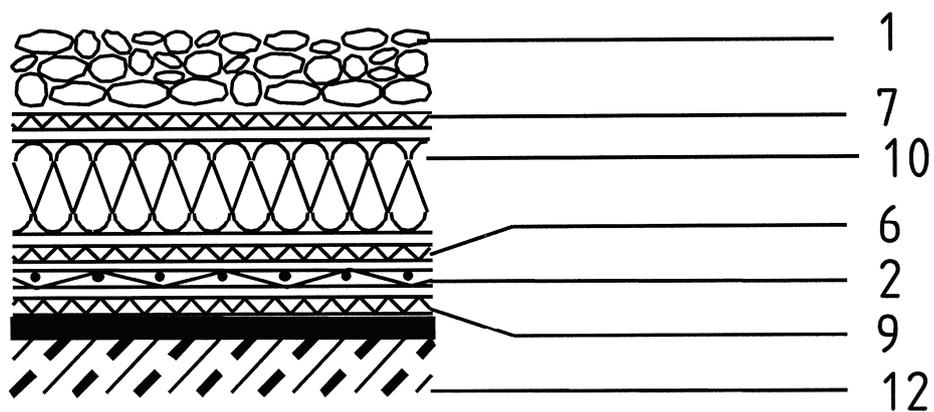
„Umkehrdach“ mit Kiesauflast
